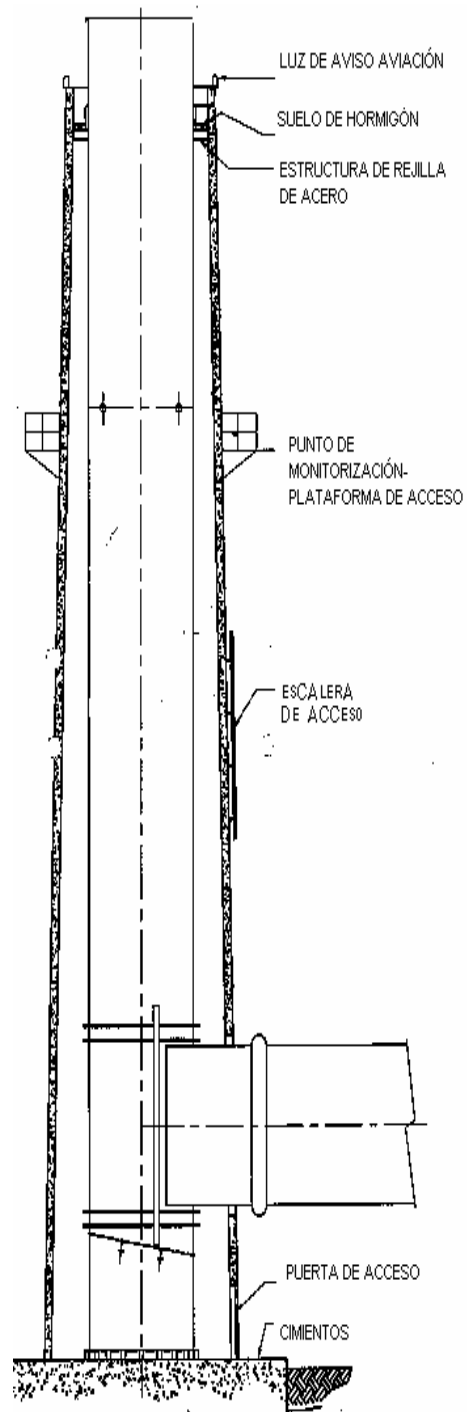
Chimenea de hormigón con conducto interior de acero, soportado en la base
